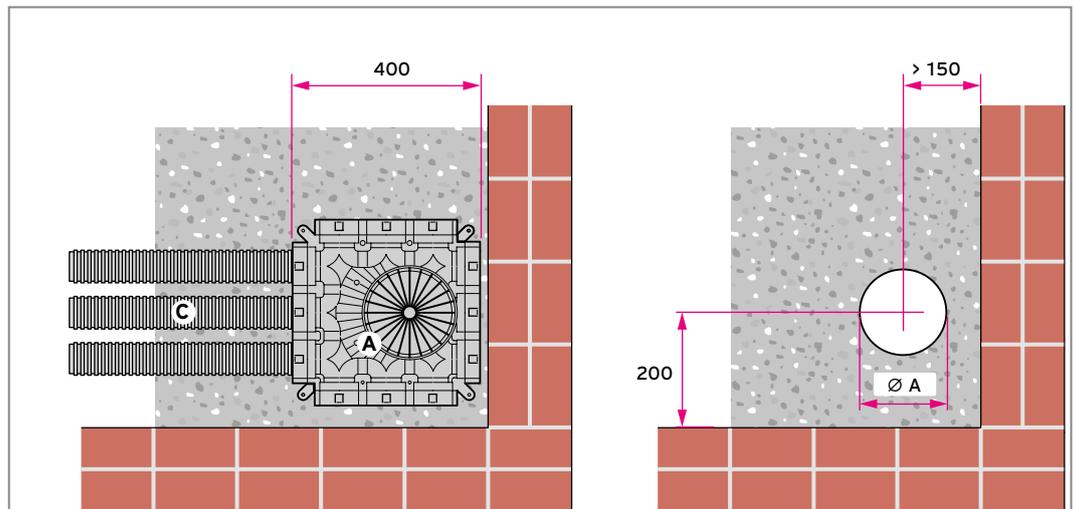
Niedrigbauverteilter/ -sammler für runde Luftschläuche in der Rohbetondecke, Draufsicht
